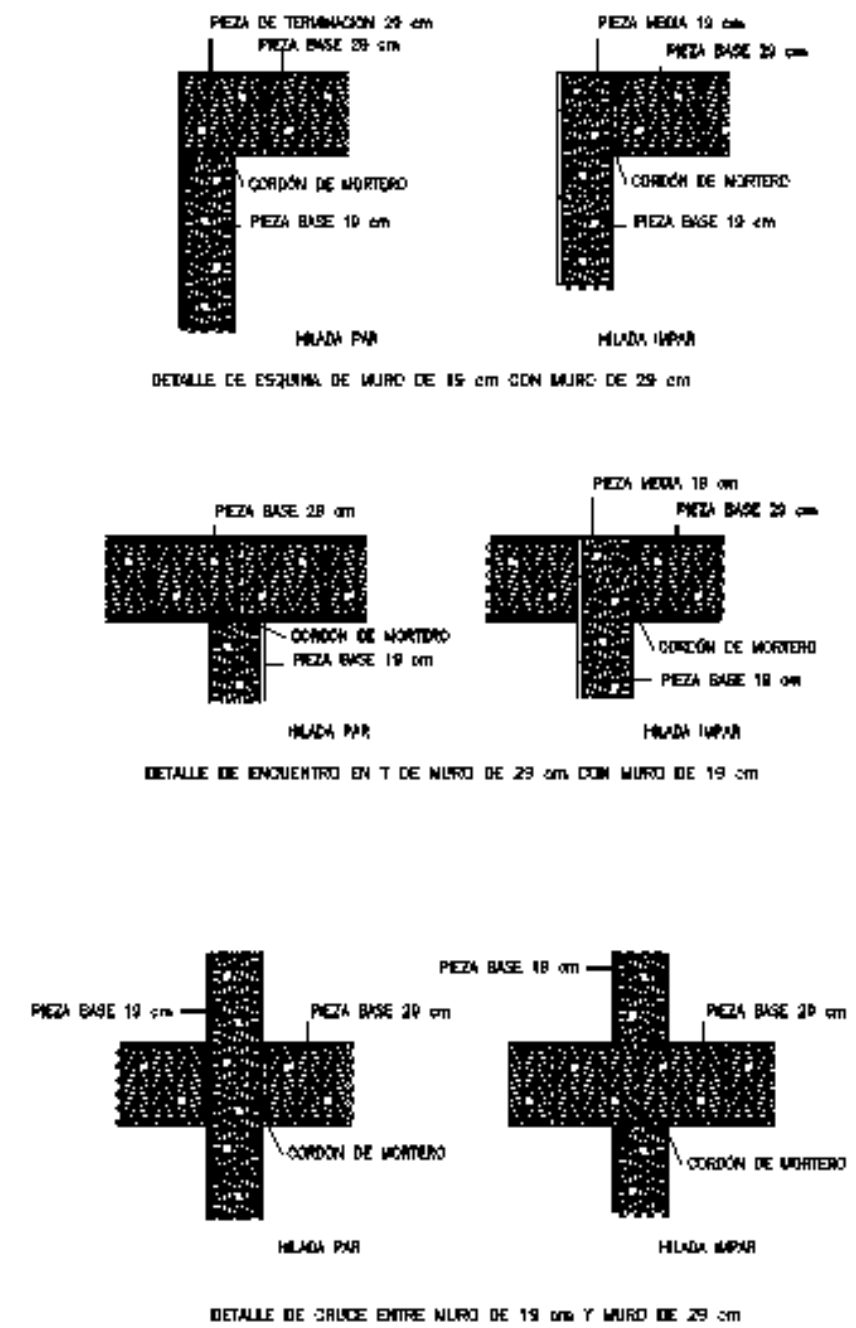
Detalles de encuentro de piezas de 19 cm con piezas de 29 cm.
